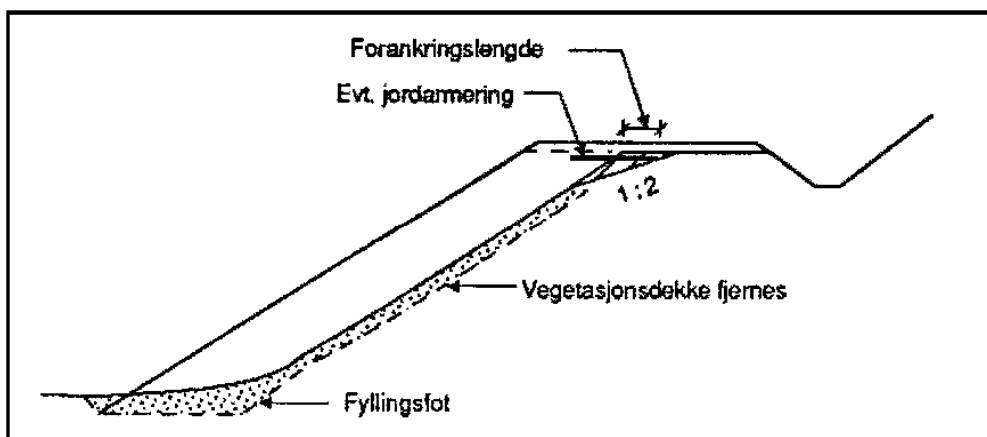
12 Komprimering av underbygning (fyllinger)
